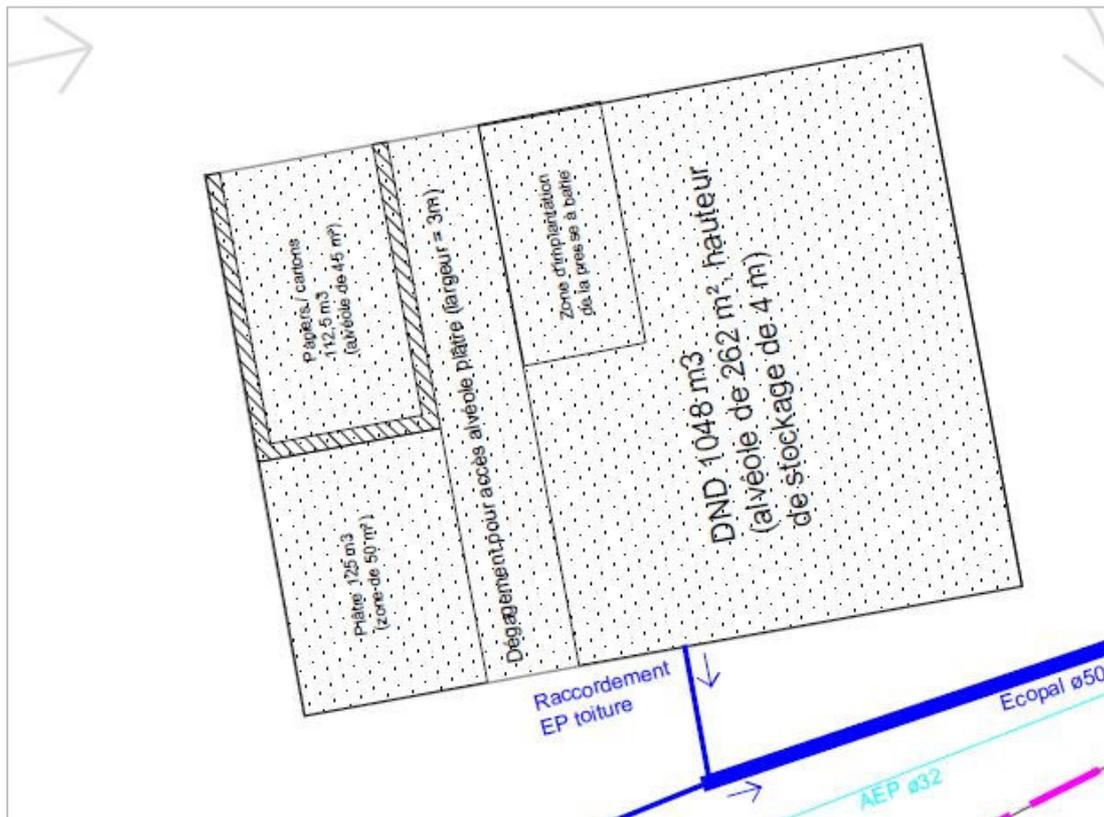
Bâtiment de transit de déchets non dangereux (extrait plan d'ensemble)
